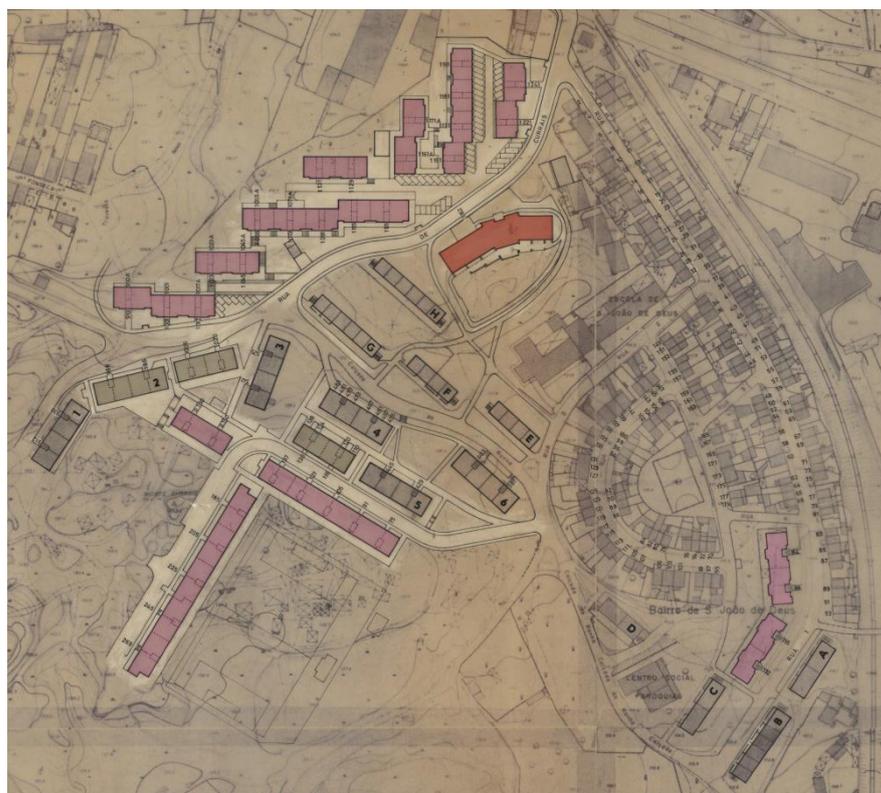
Planta da estruturação urbanística feita no bairro entre 1990 e 1999.
